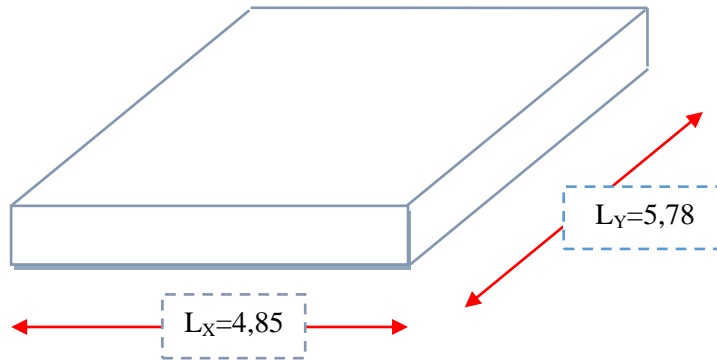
Vue en plan des dimensions du panneau le plus sollicité.
